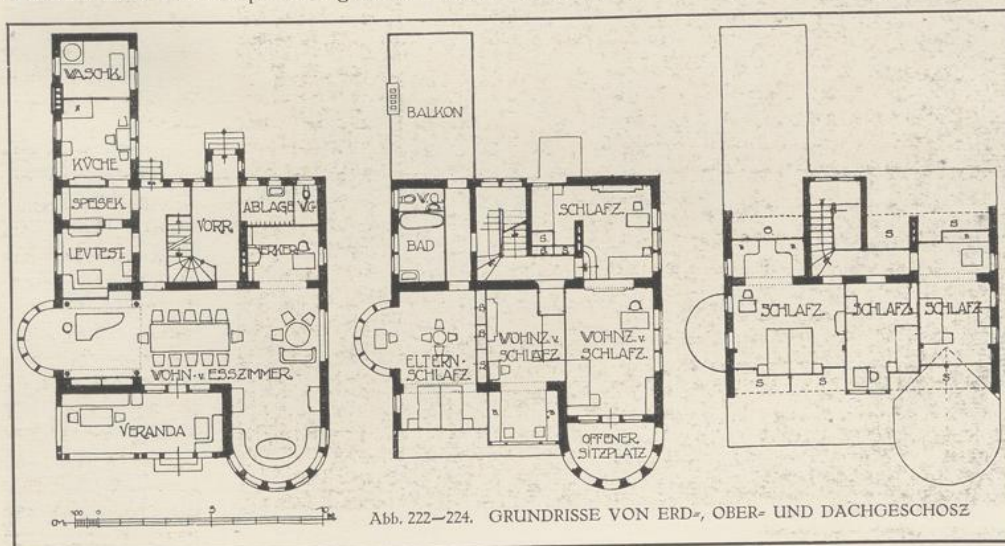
GRUNDRISSSE VON ERD-, OBER- UND DACHGESCHOSZ
